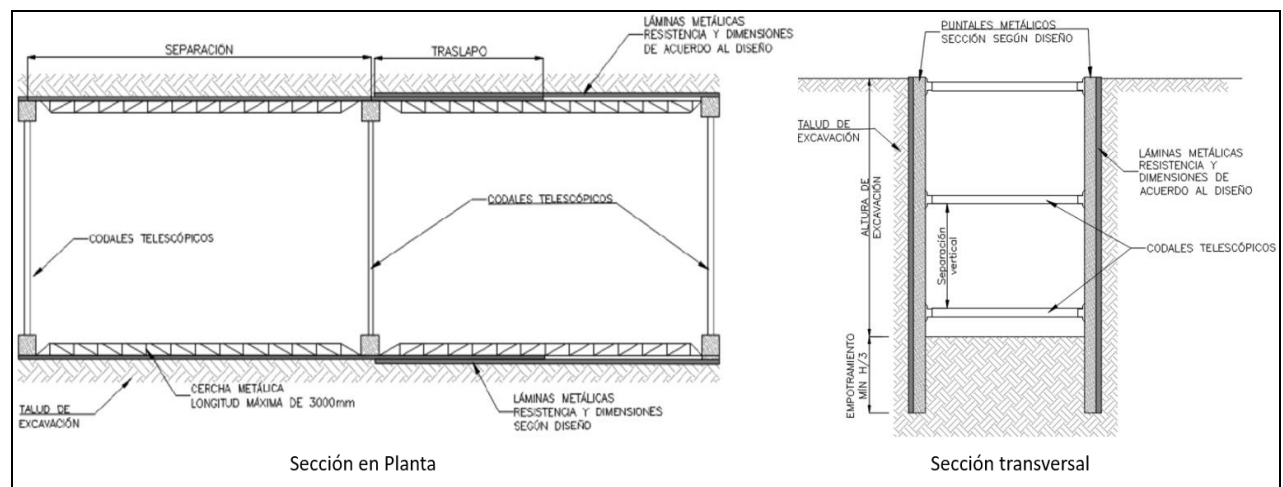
Detalle proceso de entibado metálico para soporte temporal en procesos de excavación para cimentaciones. Tomado de Norma De Construcción Estructuras Temporales De Contención-EPM.
